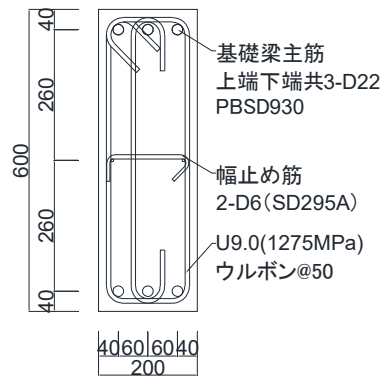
試験体 D-4 基礎梁断面詳細図
